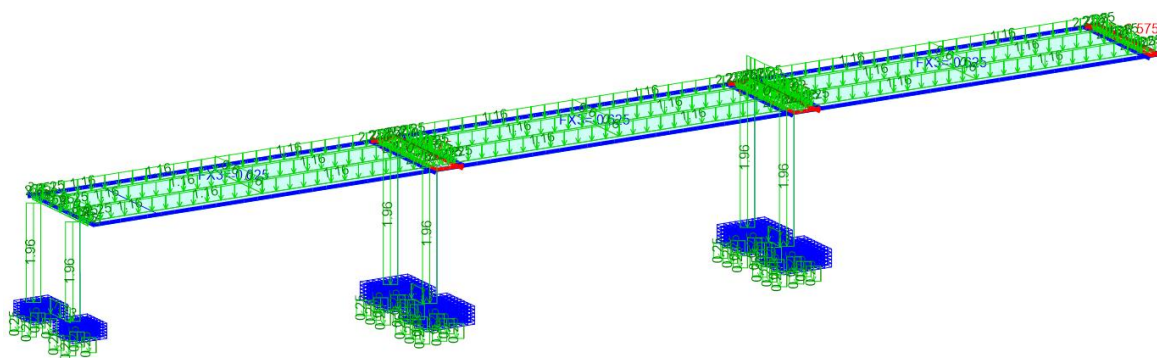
Distribuição dos carregamentos de PP dos elementos estruturais
